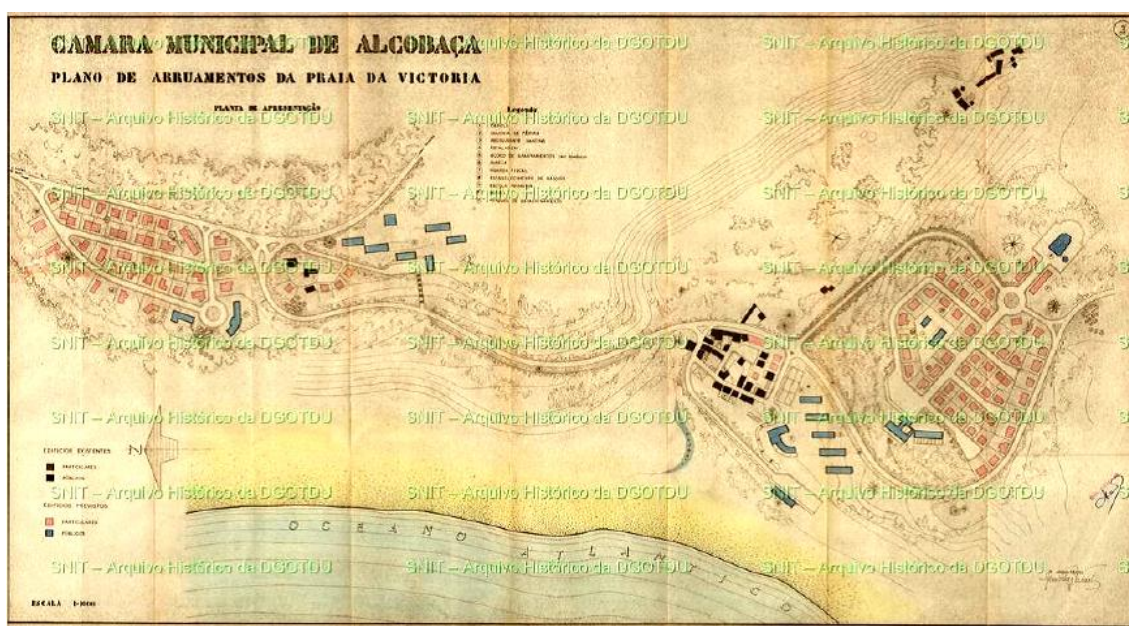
Plano de arruamentos de Paredes da Vitória, 1964. Fonte: www.dgotdu.pt
